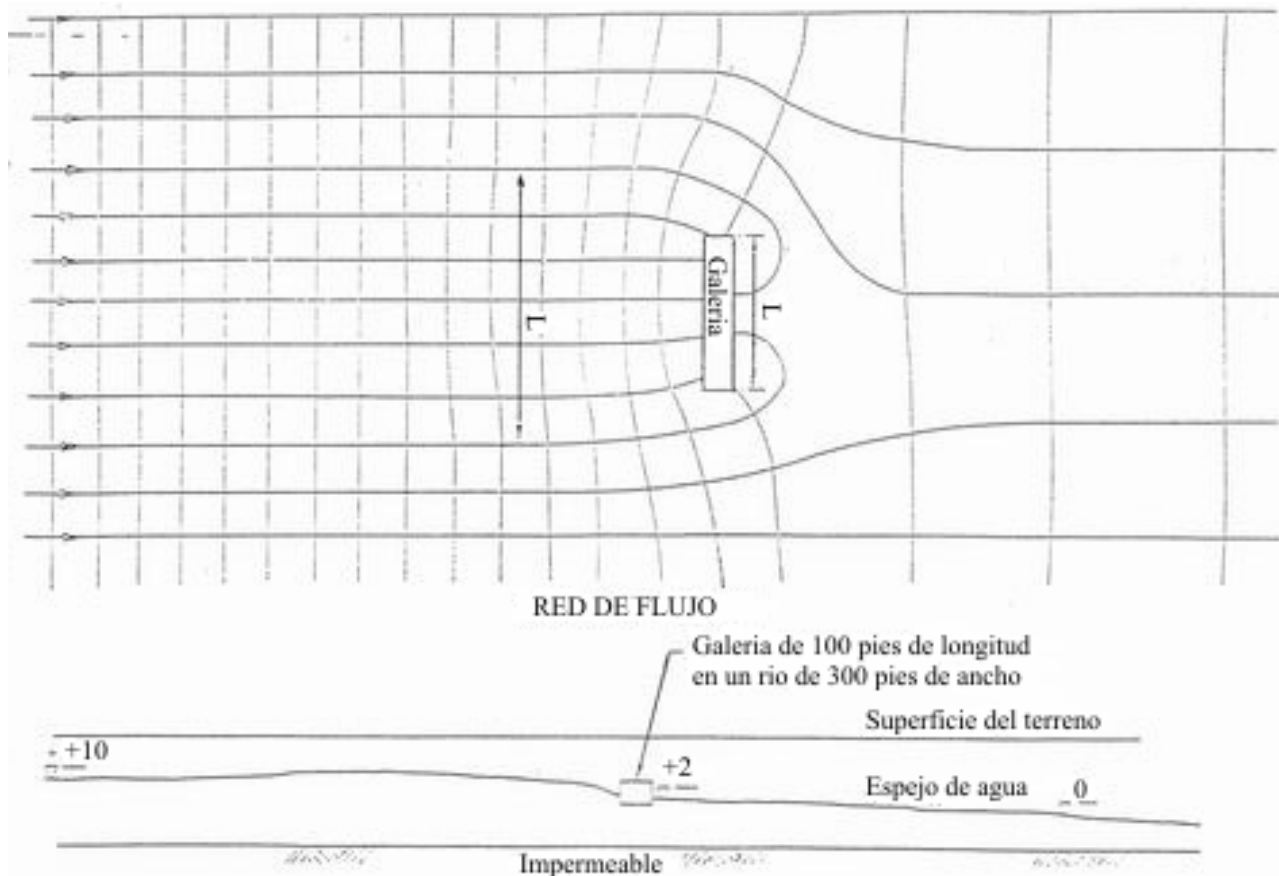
Red de flujo hacia la galería en un plano aluvial ancho
